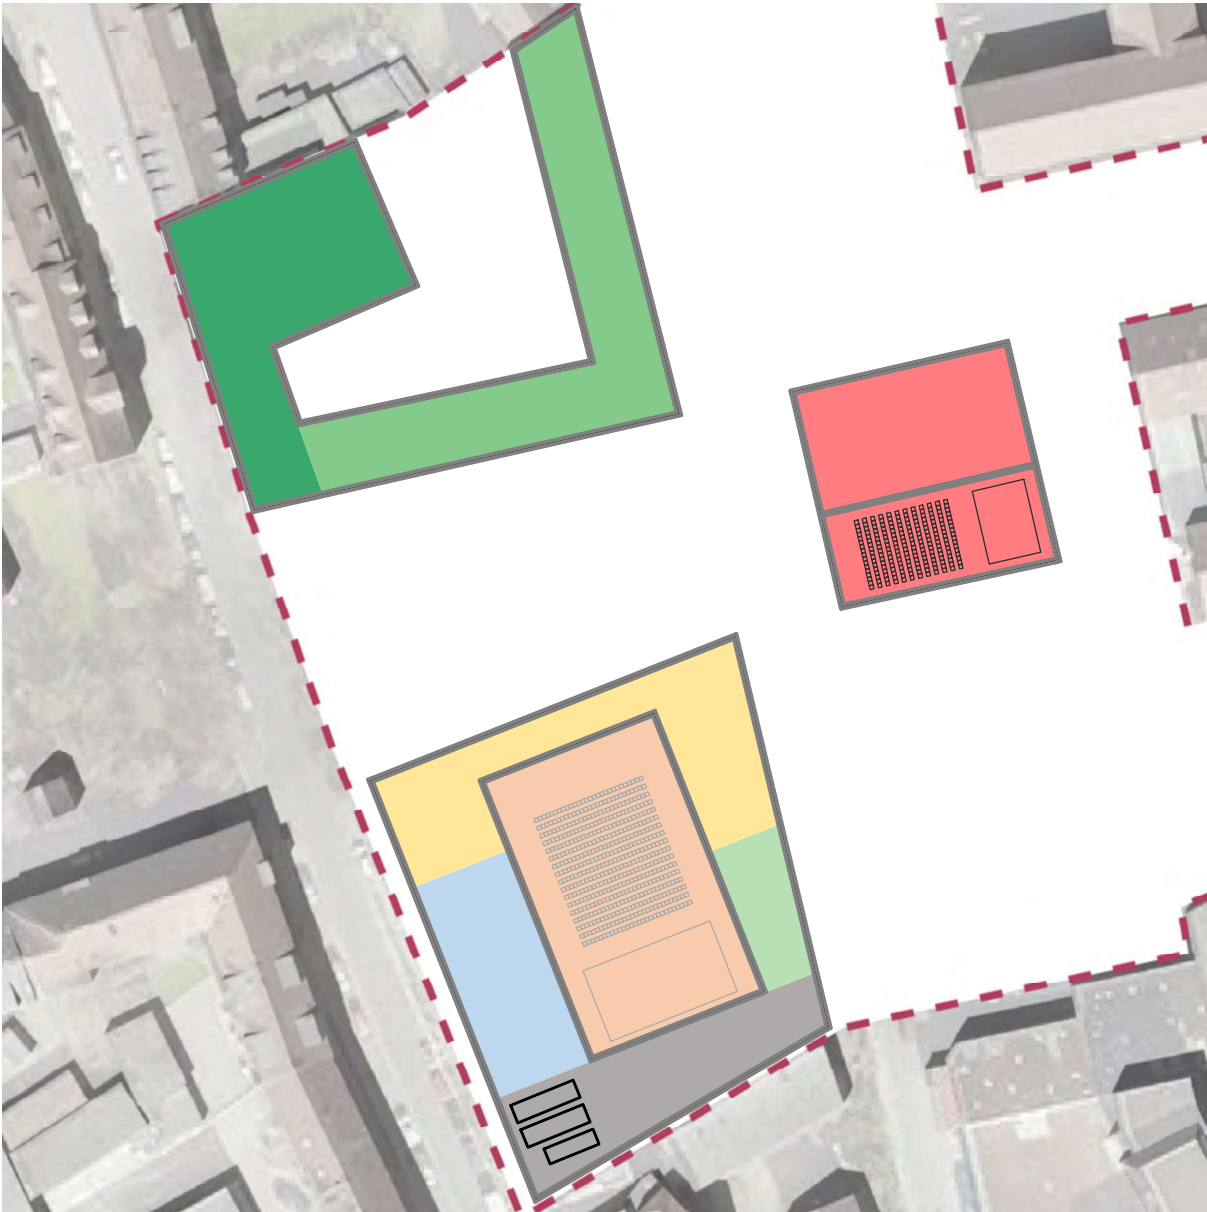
Grundriss EG Großer Hof V2
